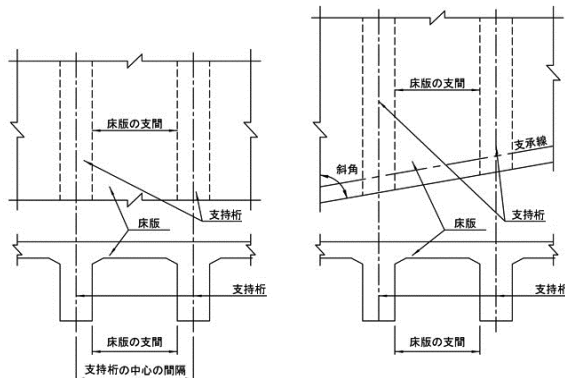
単純版及び連続版の支間（道示Ⅲ編, 図-9.2.2）
